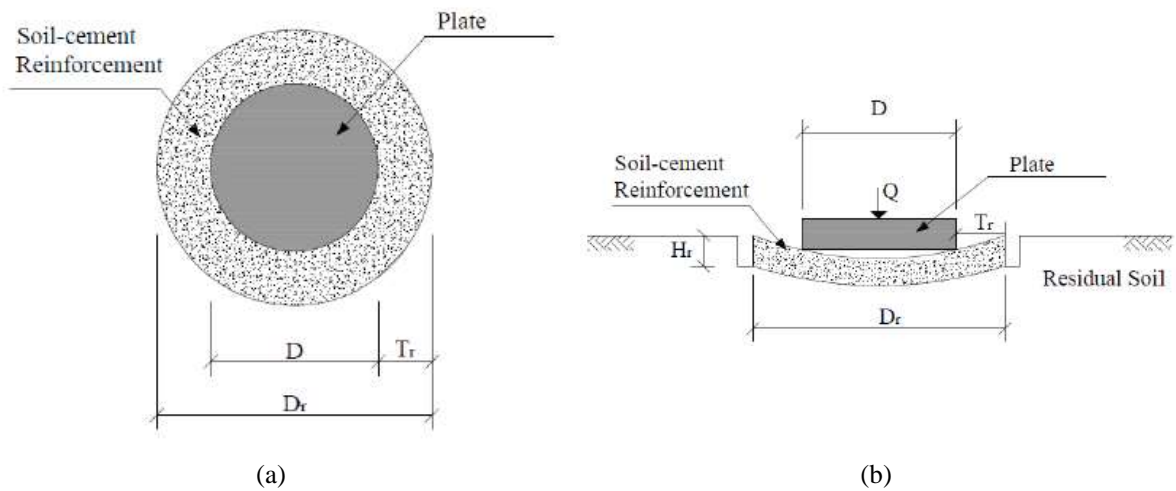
Modelo de fundação circular apoiada em camada reforçada circular de solo-cimento (a) visão em planta (b) visão em corte (CONSOLI et al., 2020)
